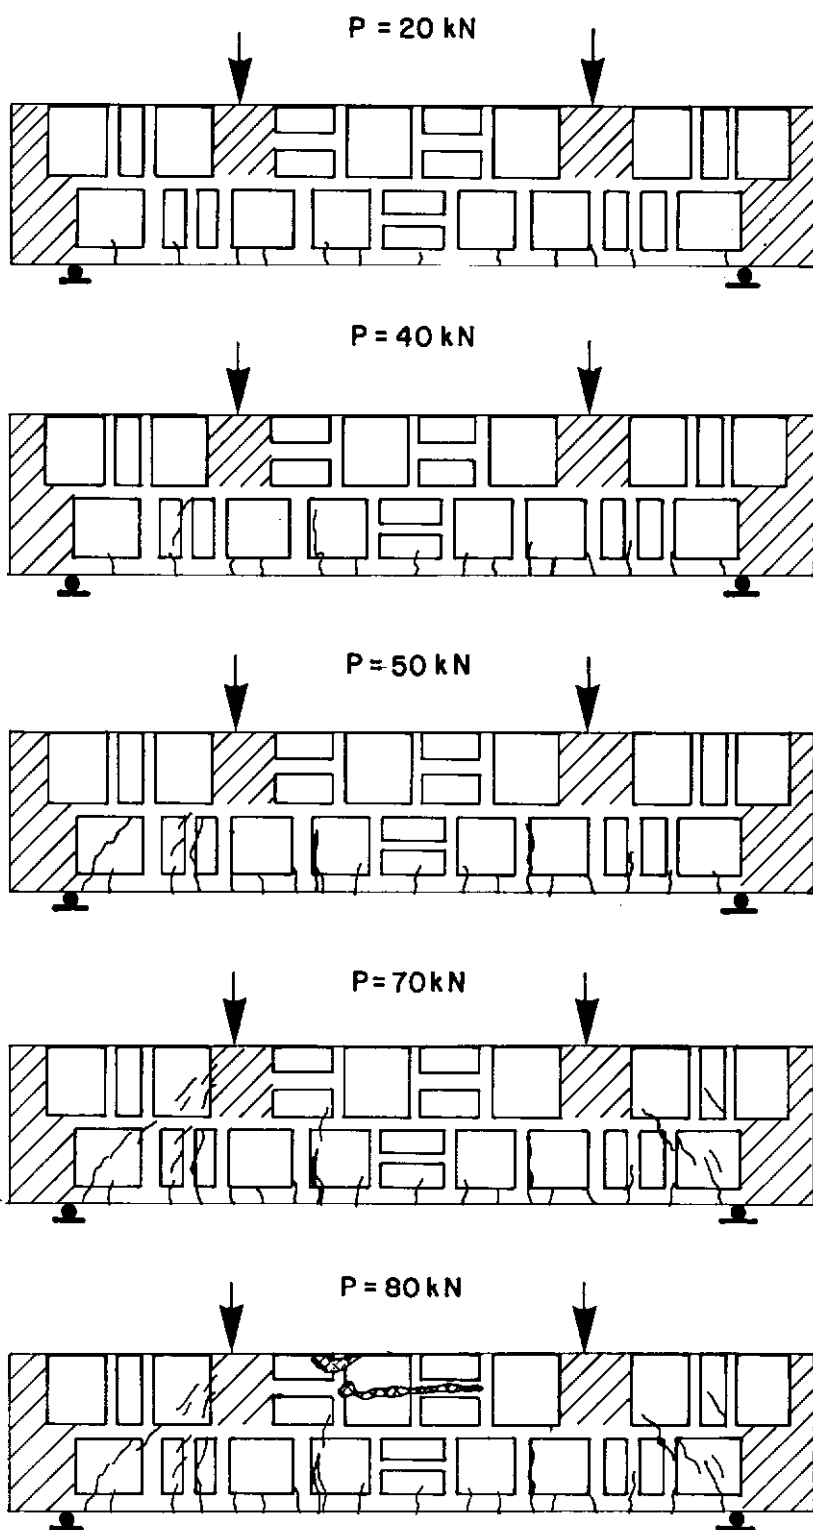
FISSURAÇÃO DA VIGA V1B^{SB}
